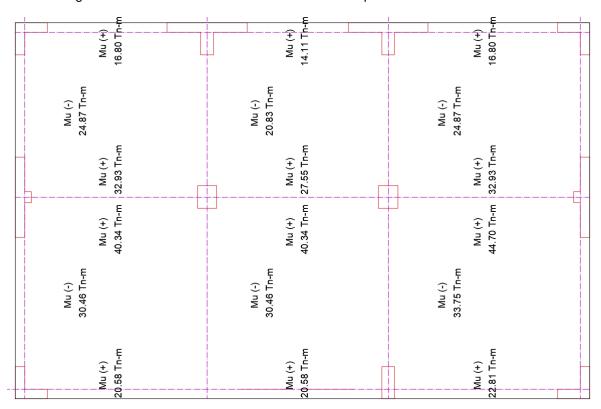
Momentos flectores en la dirección Y-Y para la losa de cimentación
